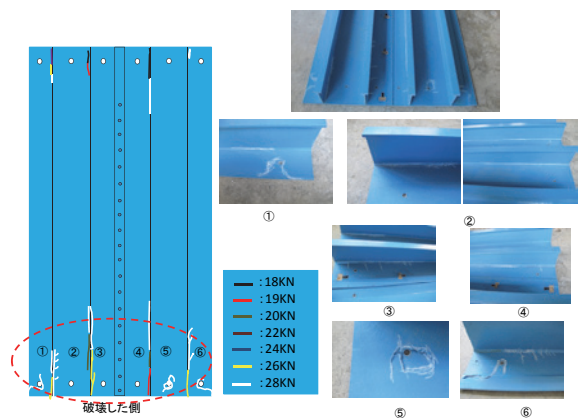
ひび割れ及び破壊状況図 (クリップタイプ)
